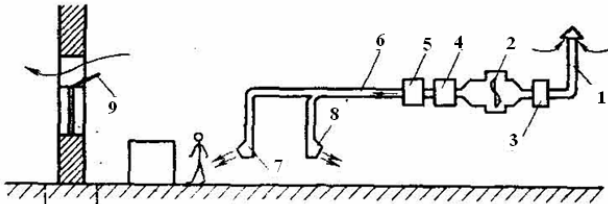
Схема улаштування місцевої припливної вентиляції: 1 - повітропровід; 2 - вентилятор; 3 - фільтр; 4 - повітронагрівач; 5 - охолоджувач; 6 - повітропровід; 7, 8 - припливні насадки.
